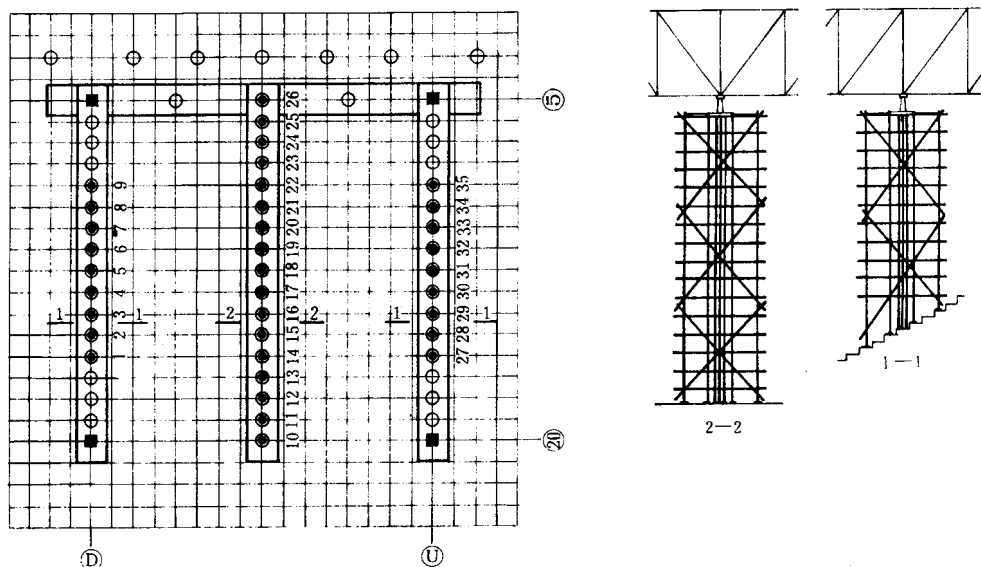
网架钢结构脚手架及临时支承点平面图
